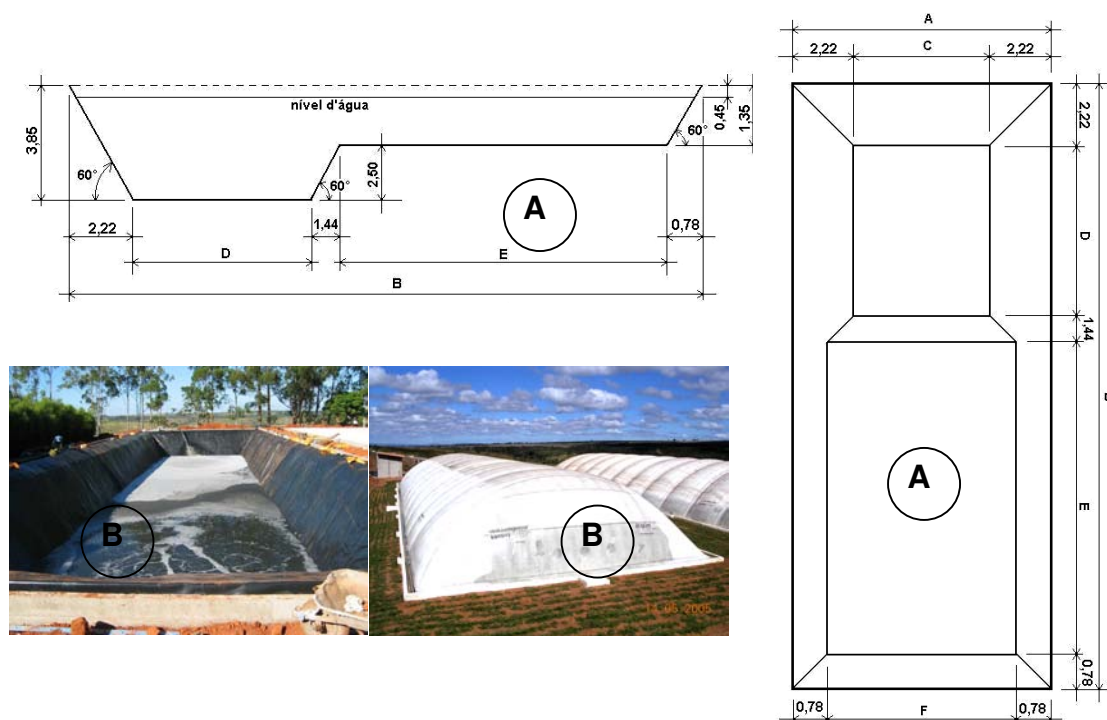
Modelo de biodigestor adotado pela empresa AgCert, em planta baixa (A) e construído (B)
